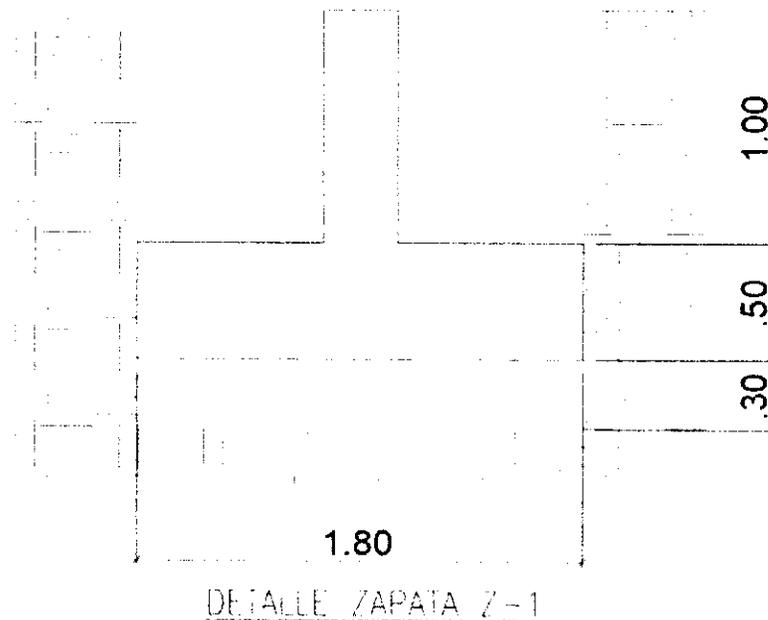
Detalle zapata aislada 1.80x1.80 mts.
